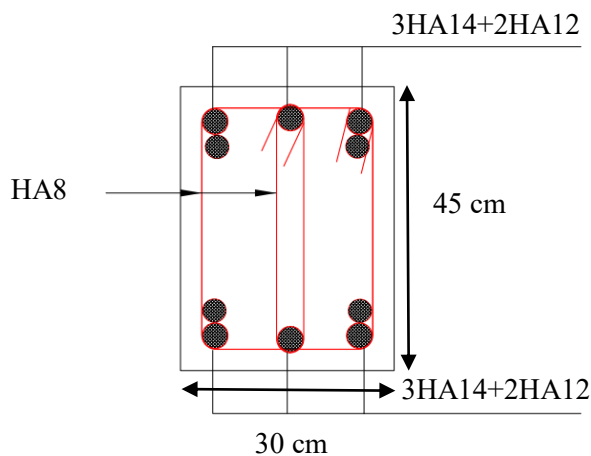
Ferrailage des poutres principales en travée 30x45
